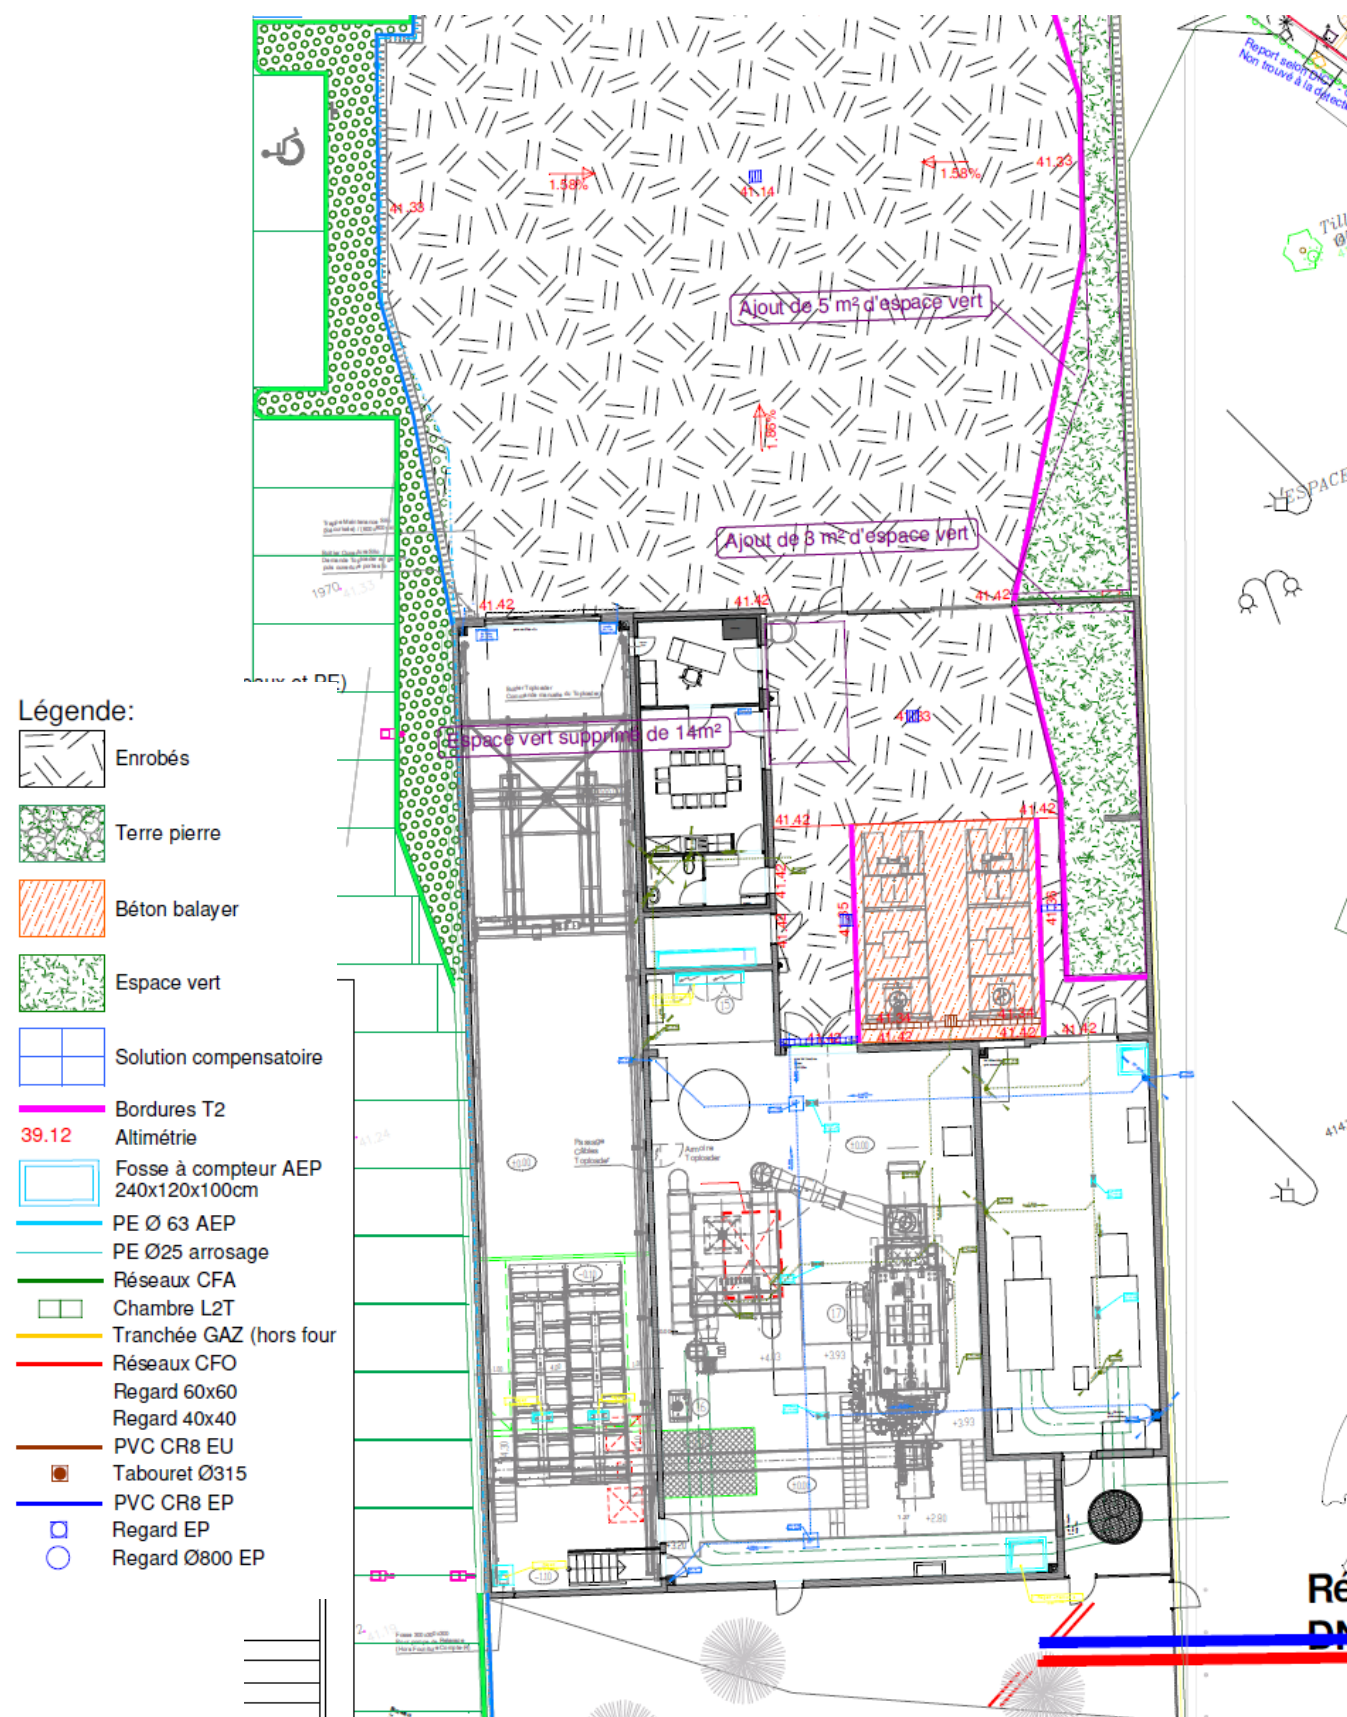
Plan de la chaufferie biomasse, mai 2023
